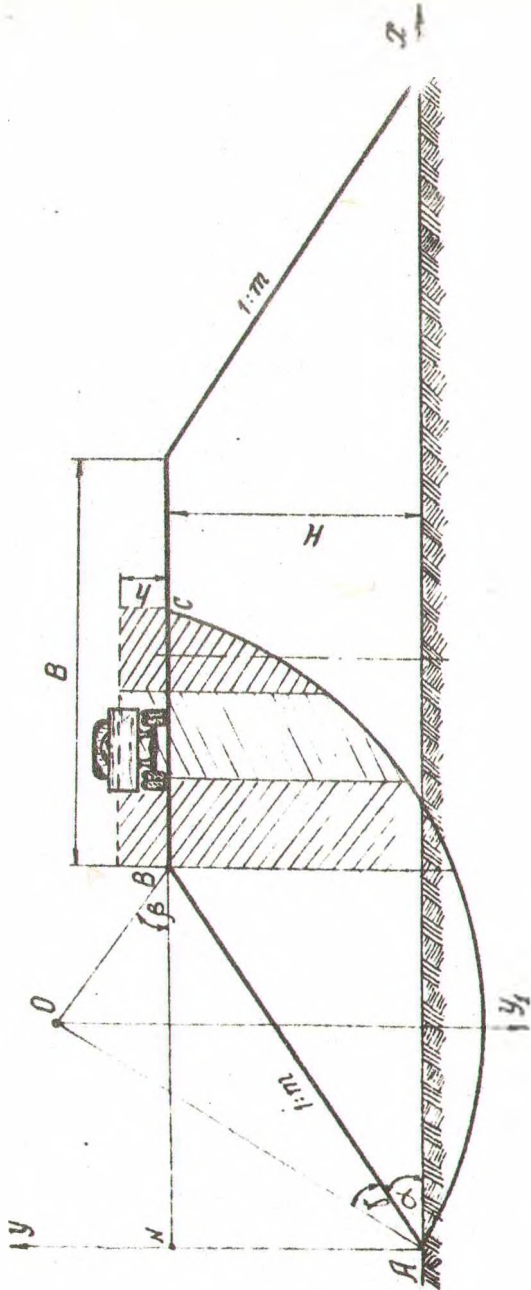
Расчетная схема для насыпи с внешней нагрузкой
